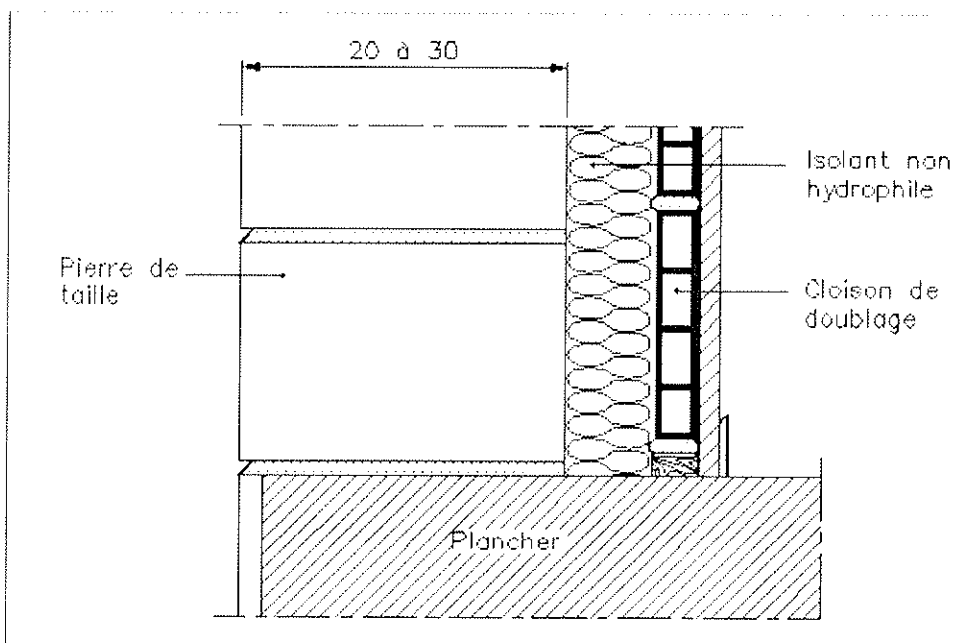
Moellons taillés ou pierre de taille/murs du type IIb/épaisseur minimale de la paroi extérieure en pierre
